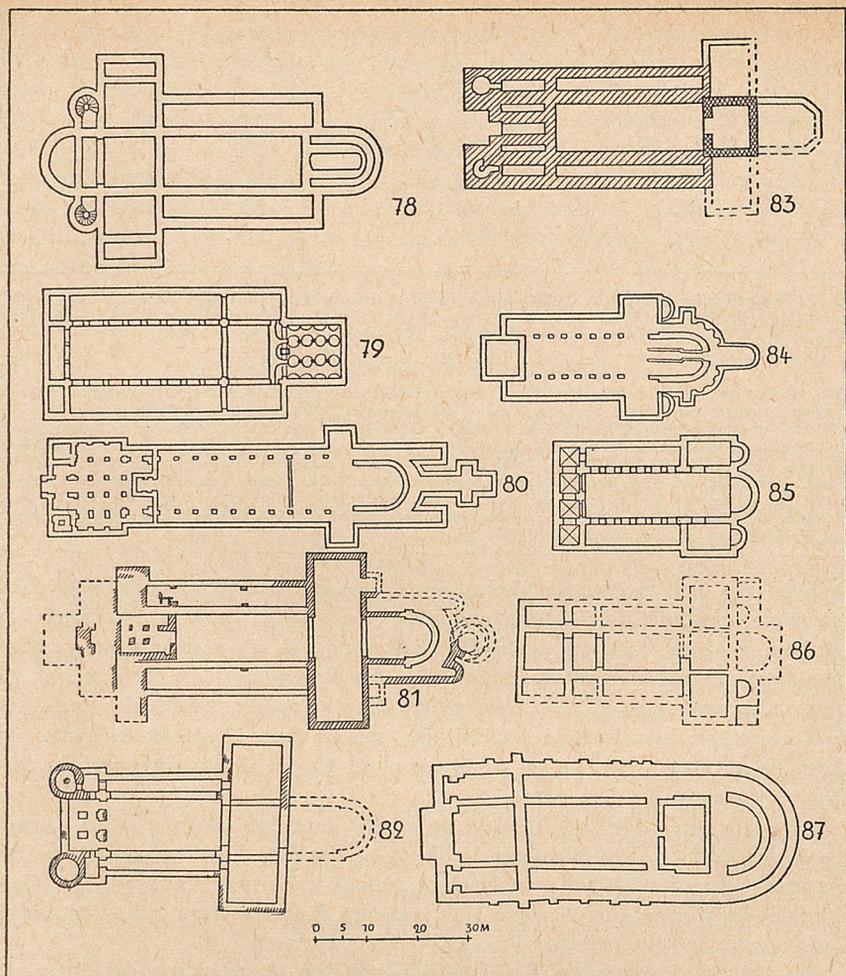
Dreischiffige Kirchen: 78. Paderborn, Abdinghofkirche Bau II, 799 gew. Nach Ortman (siehe Thümmler II 104 und 102). - 79. Desgl. Bau III, 1016/31. Nach Thümmler (I 152). - 80. Korvey, Klosterkirche, 844 gew. mit Westwerk 873-85. Nach Esterhues (II 107). - 81. Hildesheim, Dom. Nach Bohland: Rundkapelle I 774/5, Rundkapelle II um 815; Altfrieddom 852/72 mit Westkrypta und 2 Türmen, dreitürmiger Westbau Godehards 1022/38, Langhaus Hezilos 1055/61, Ostapsis 1119/30 erneuert (Alt Hildesheim, Heft 25, 1954). - 82. Möllenbeck, Stiftskirche, nach Klessmann 10. Jh. (II 241). - 83. Minden, Dom. Chorviert wohl vom einschiffigen karoling. Bau um 800; Langhaus und Westwerk 952 gew.; Querschiff und Chorerweiterung 1072 gew. Nach Thümmler (II 105, vgl. auch II 104). - 84. Vreden, Stiftskirche, Zustand Ende des 9. Jh. Nach Winkelmann und Claussen (II 106). - 85. Herdecke/Ruhr, um 820. Nach Petermeise (I 52). - 86. Speyer, Stiftskirche St. German, Bau II Anfang des 11. Jh. Nach Kaiser (I 14). - 87. Lausanne (Schweiz), Kathedrale um 1000. Nach Verdier in: Frühmittelalterl Kunst 1954. Nicht maßstabgerecht.
